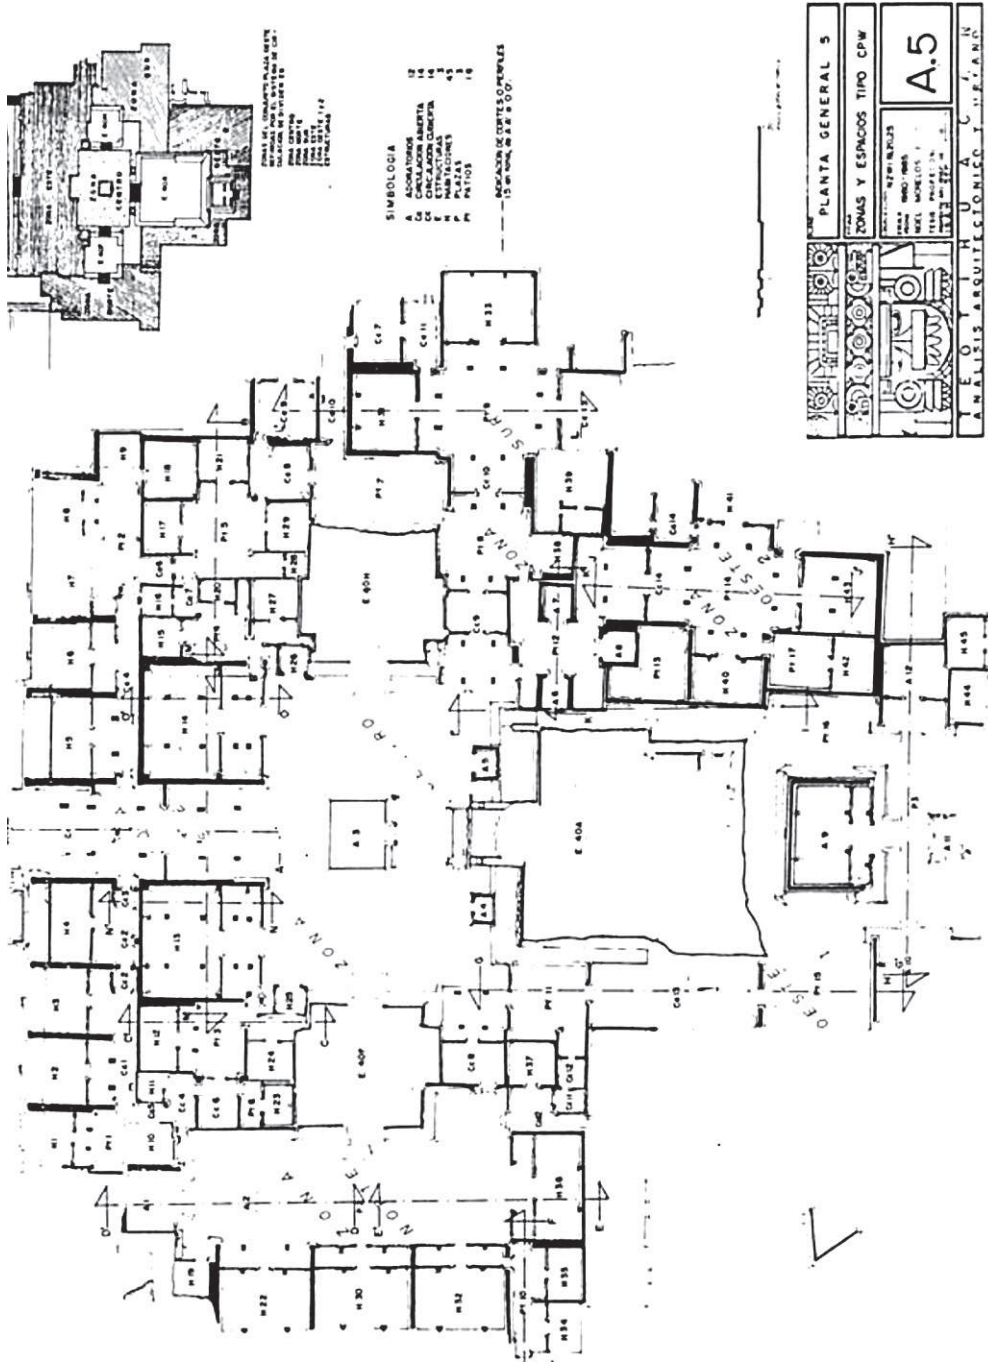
Plano del conjunto Plaza Oeste, elaborado por Noel Morelos en 1982. Este plano Constituye los resultados del proyecto de excavación. Tomado de Morelos 1993.
